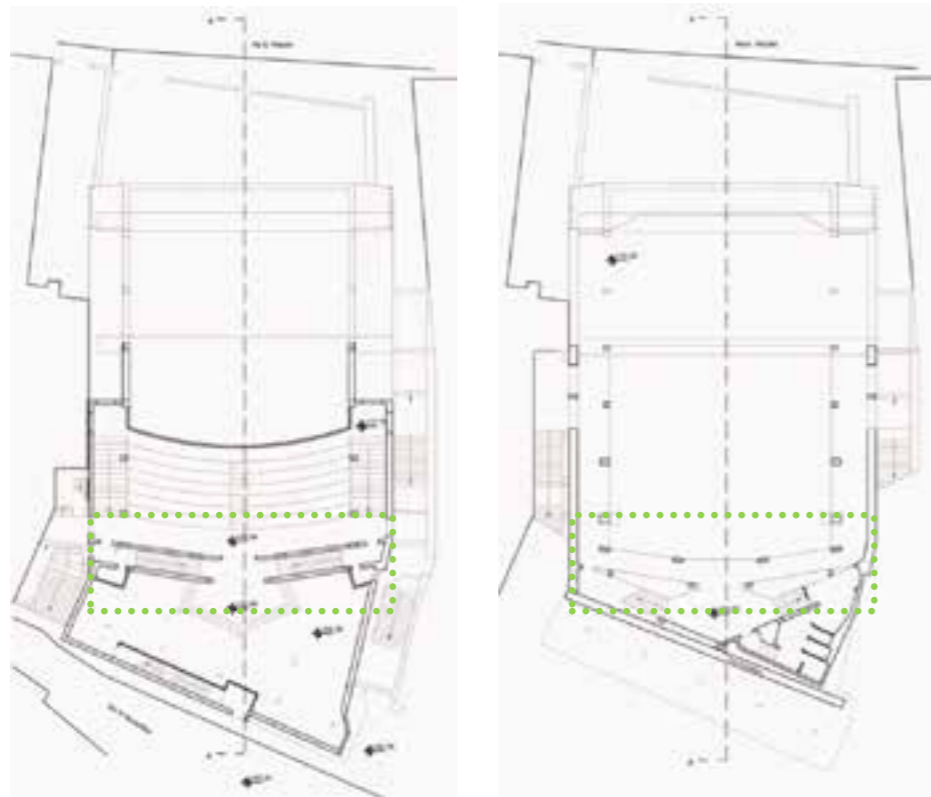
Pianta Atrio-Galleria q:+20.58/+17.76; Pianta Platea q:+15.43/+13.3 con individuazione delle due rampe di scale
